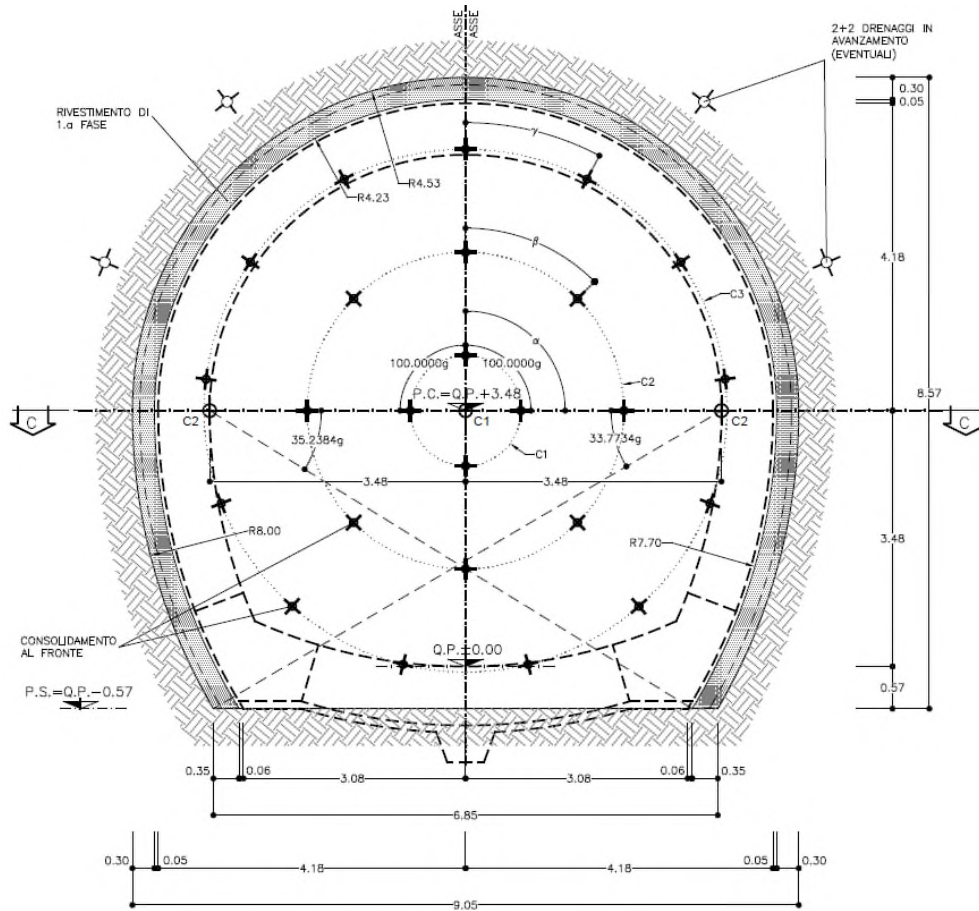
Sezione Tipo B2 – Scavi e consolidamenti - Sezione
